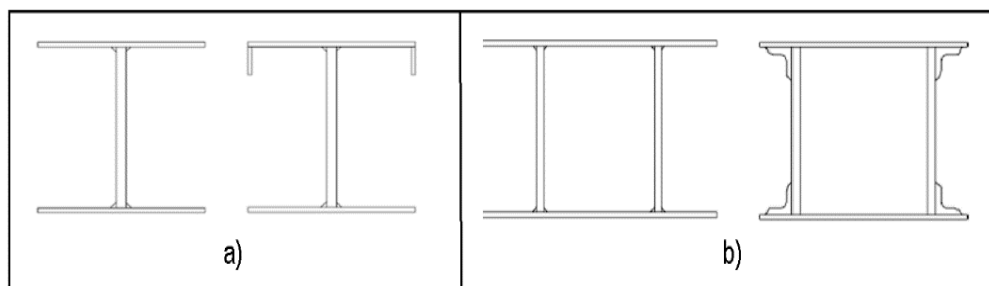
Vigas de perfil Reforzadas armadas, a) tipo I, y b) tipo cajón. Brotóns (2006)
